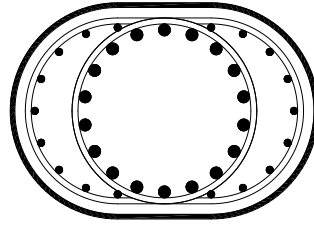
Ensanchamiento de la parte superior de la columna de sección circular, sección oblonga (Priestley et al., 1996).
